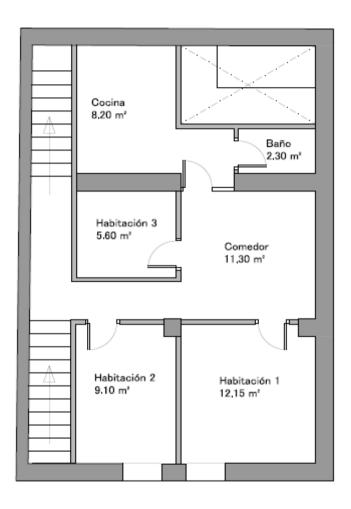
Plano primera planta de la vivienda años 1940. Fuente: Elaboración propia.
